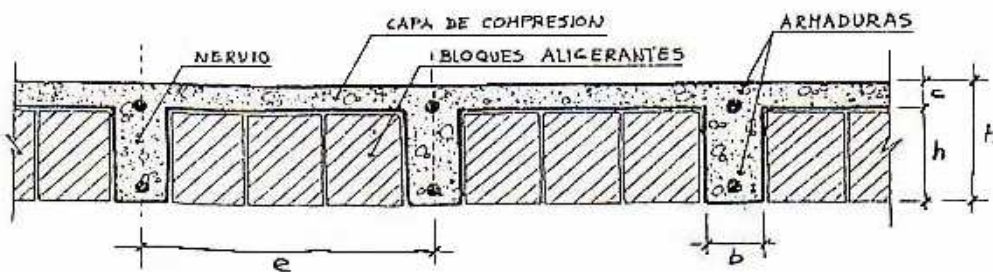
Sección transversal de la zona aligerada de un forjado reticular
